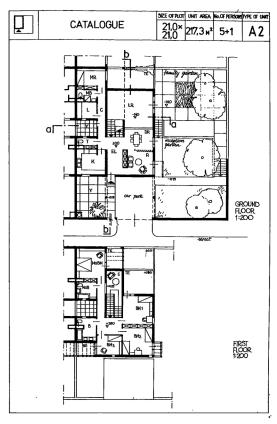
٢١): مسقط آفقي بديل للوحدات غط (Al) من كتالوج الوحدات السكنية.
